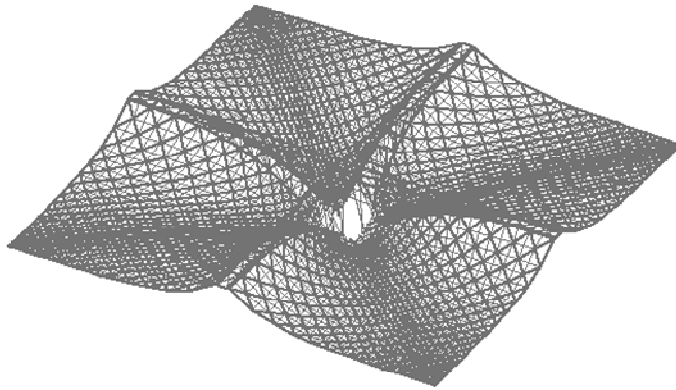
Building Conservation Centre Wielka Brytania, [352].
